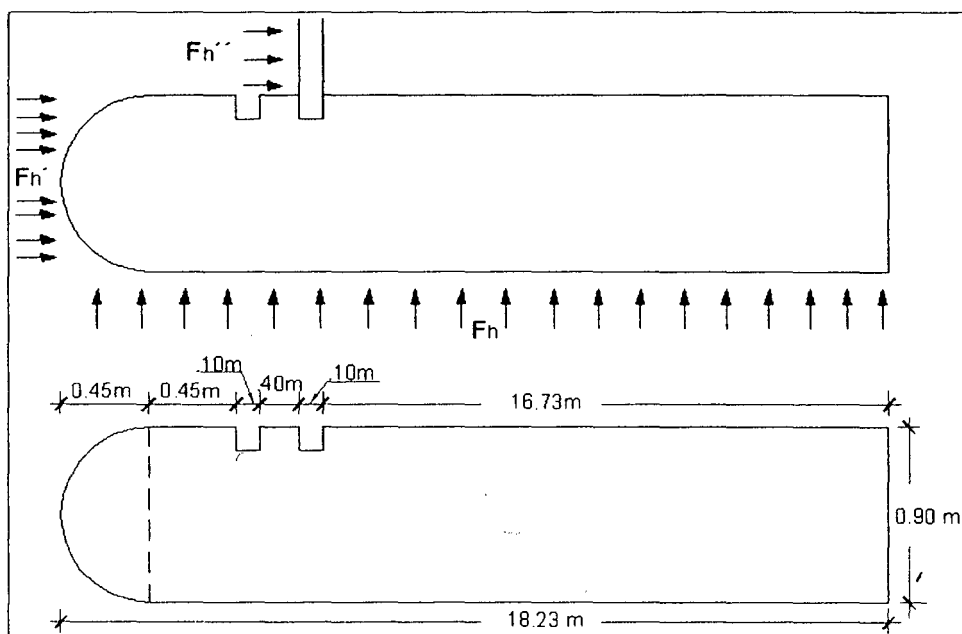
Esquema de fuerzas actuantes y dimensiones del pilar.
